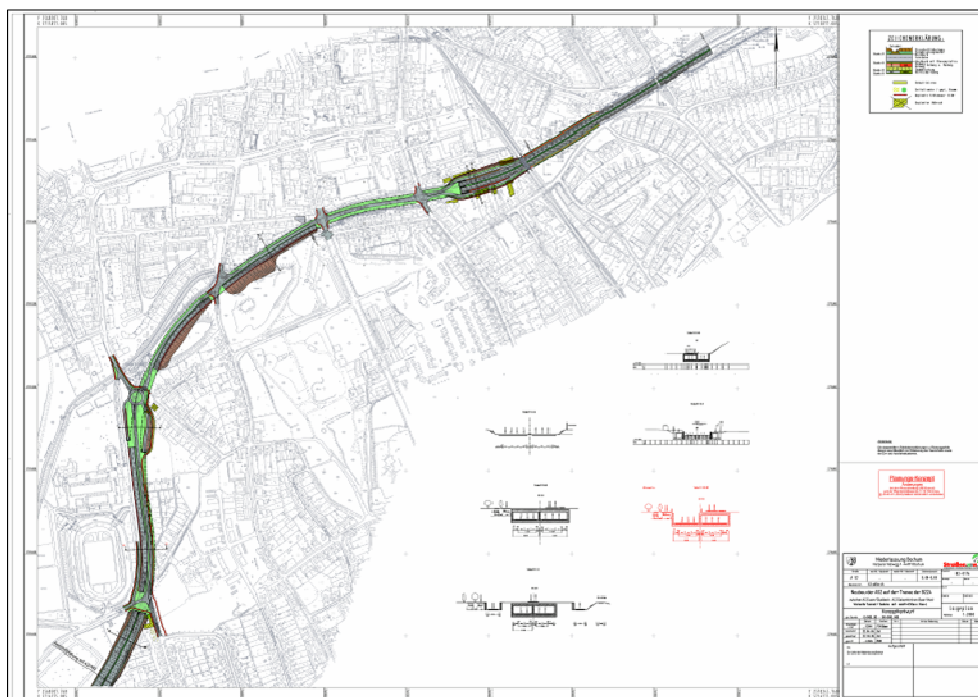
Variante 1a/b Volltunnel / Tunnelstrecken inkl. Galerien
